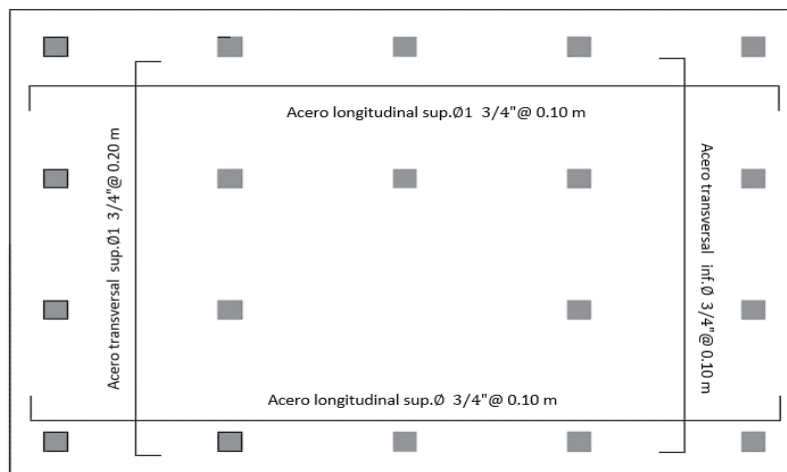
45. Distribución de acero en losa de cimentación para el edificio de 18 pisos
